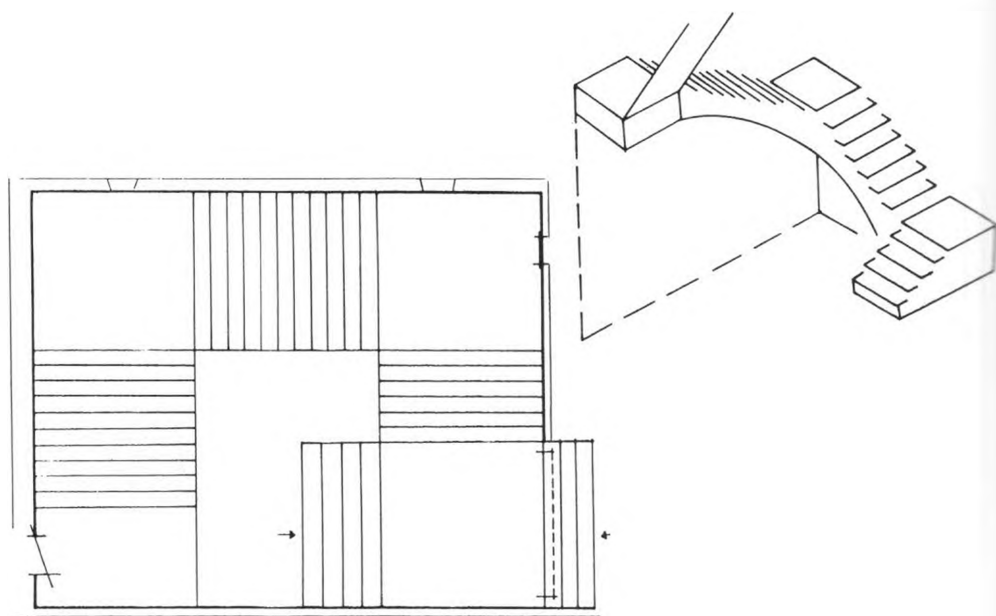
Planta y alzado de la escalera principal de la Colegiata de San Isidoro de León.
